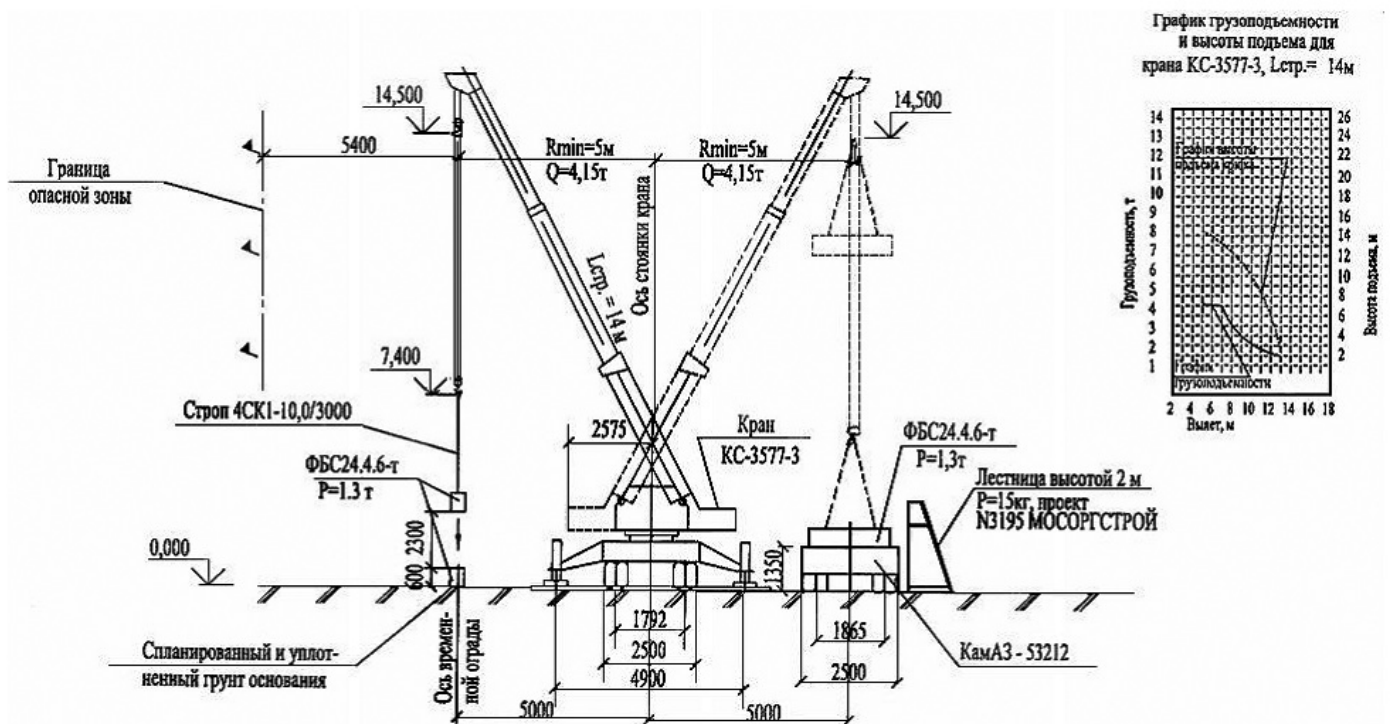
Схема разгрузки и подачи фундаментных блоков в зону монтажа
